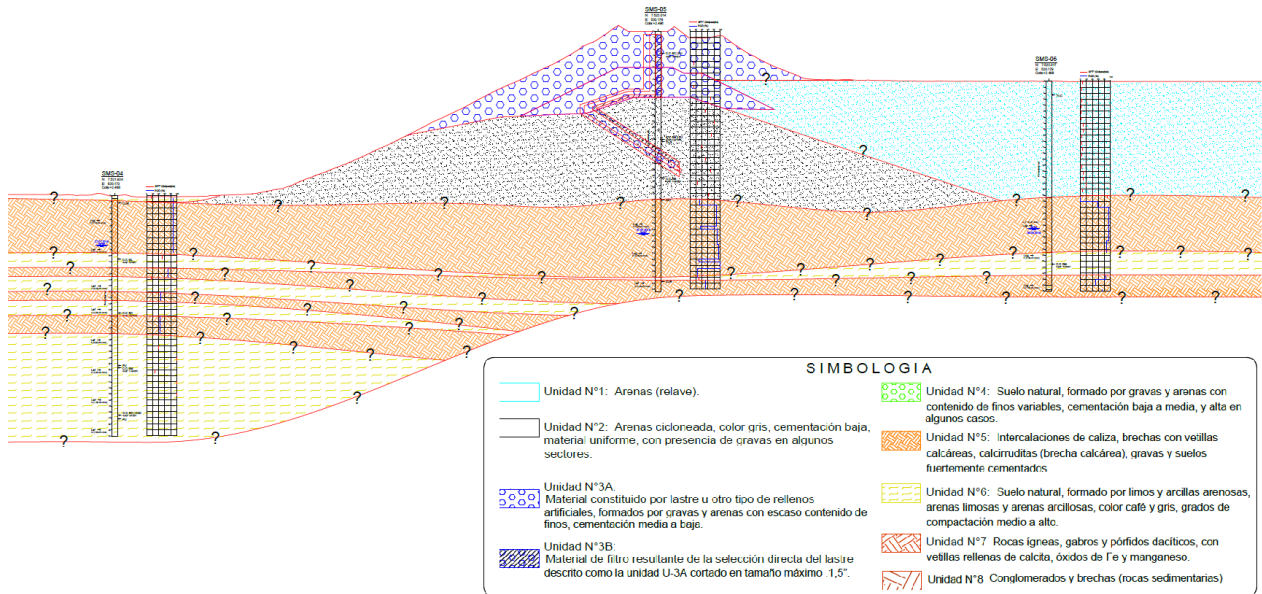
Perfil transversal del muro y suelo de fundación tomado como referente de los antecedentes, modificado. (IDIEM, 2020)
